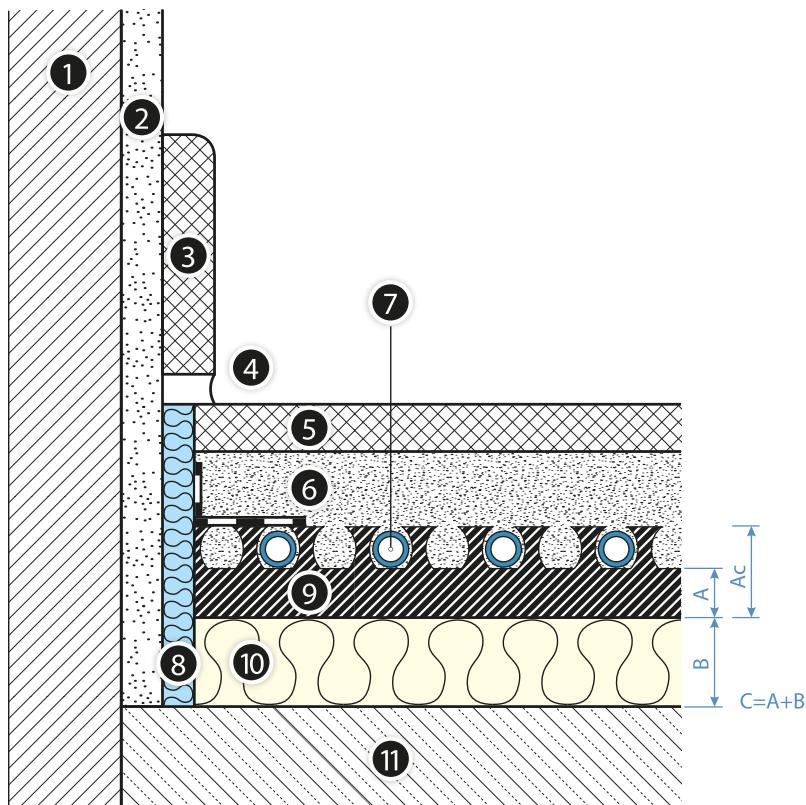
Podni grijač sa KANtherm Profil Sistem pločom na stropu unutrašnje prostorije
